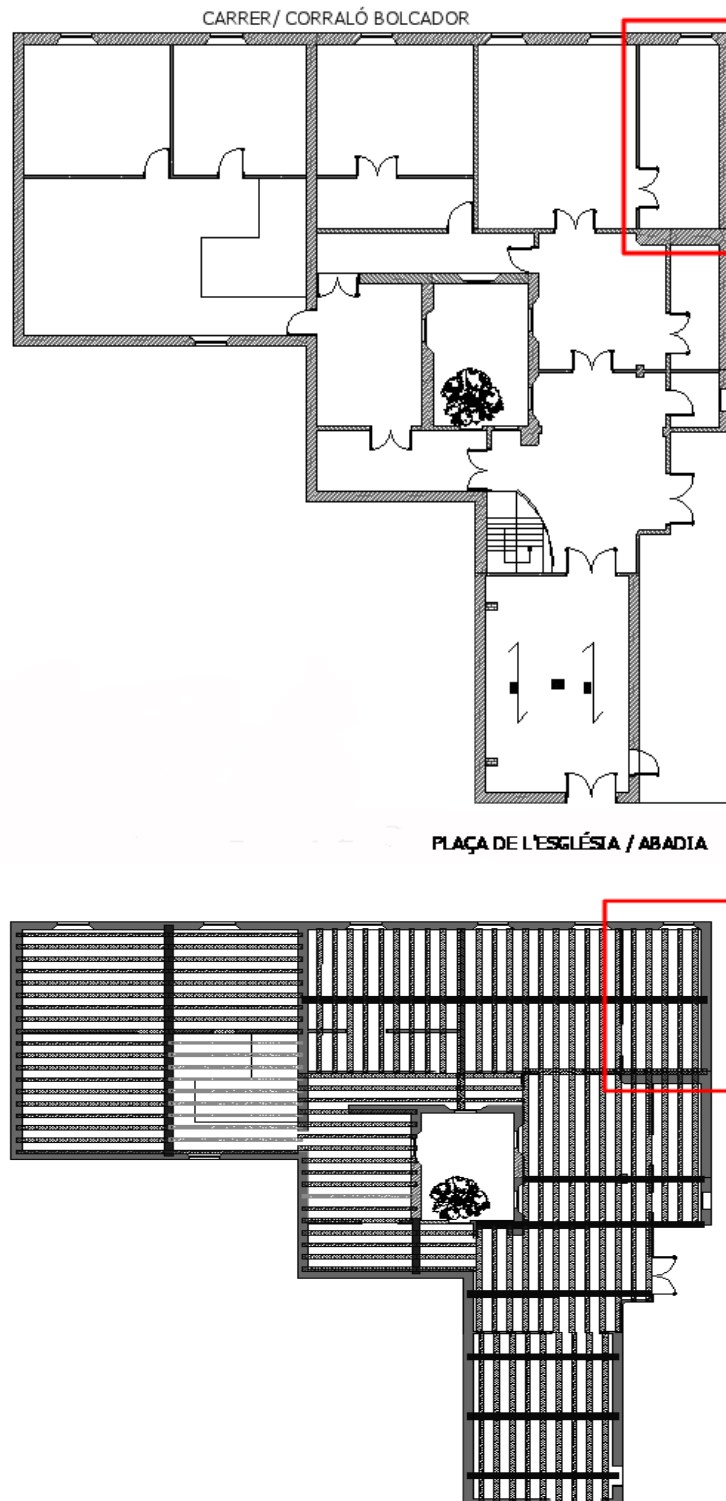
i 5.3.2. Plànols Planta Baixa.
